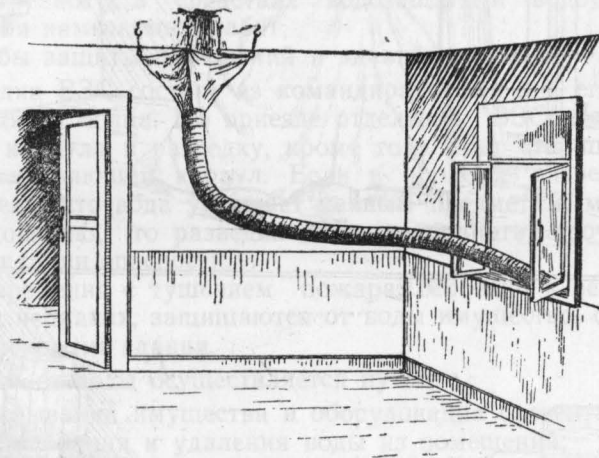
Спуск воды, просачивающейся через перекрытие верхнего этажа.
